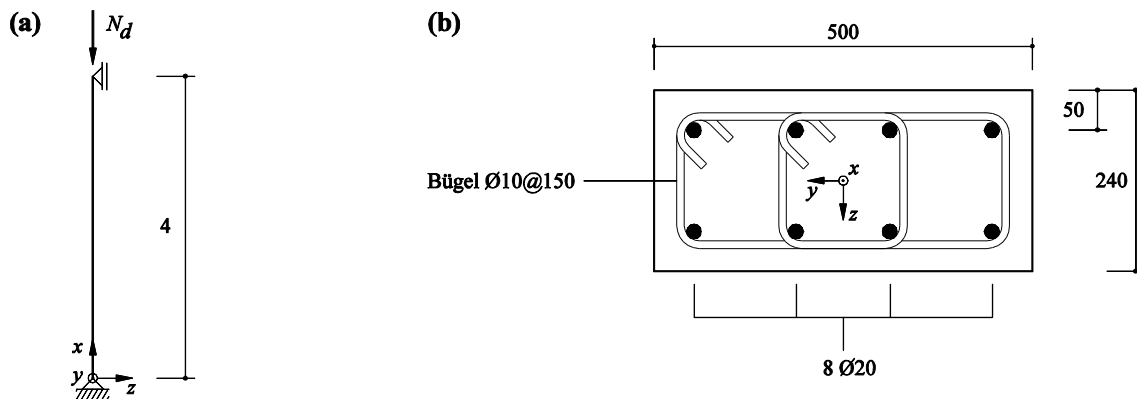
(a) statisches System und Belastung (Abmessungen in m); (b) Querschnitt (Abmessungen in mm).
